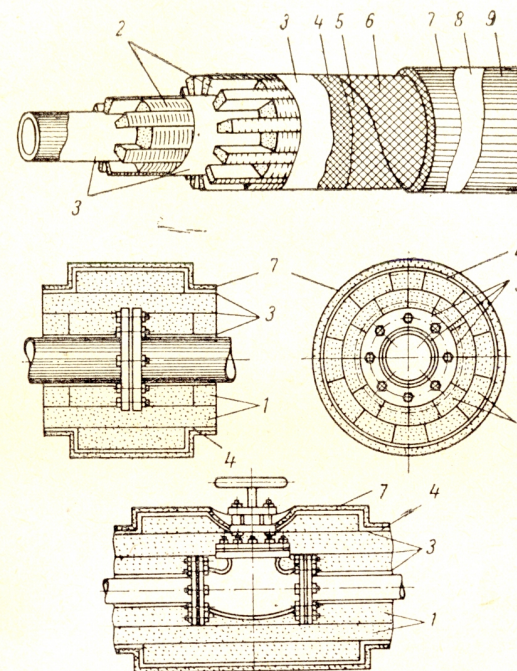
Конструкция теплоизоляции холодопроводов торфонзделями:
